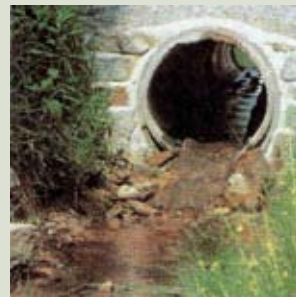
Géotextile implanté dans un tuyau en béton : chute d'eau réduite par une rampe de pierres
